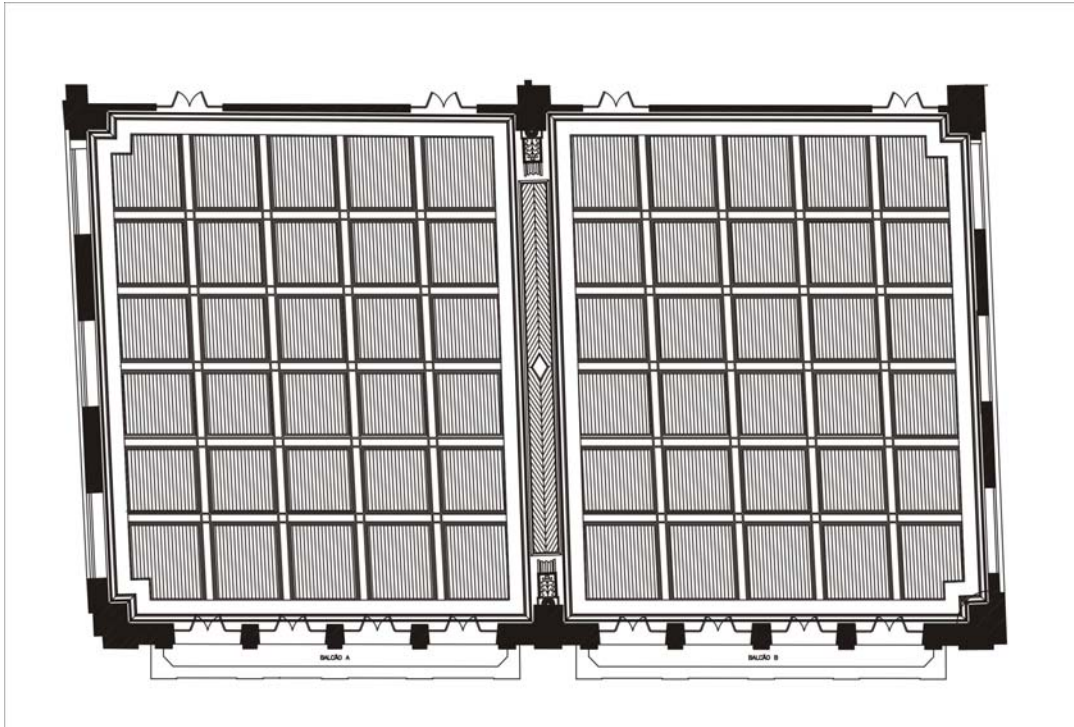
Aspecto do forro do salão do 2 pavimento, prédio Anexo.
